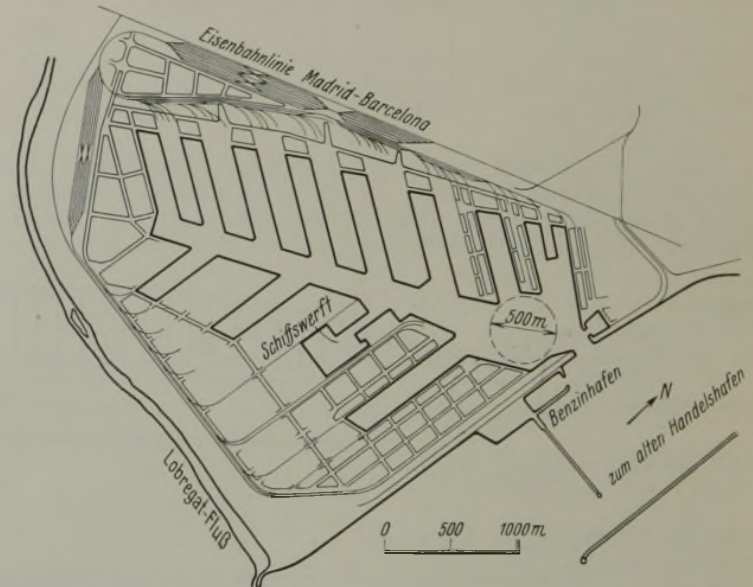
Plan des Vorschlags I, Erweiterung II.
